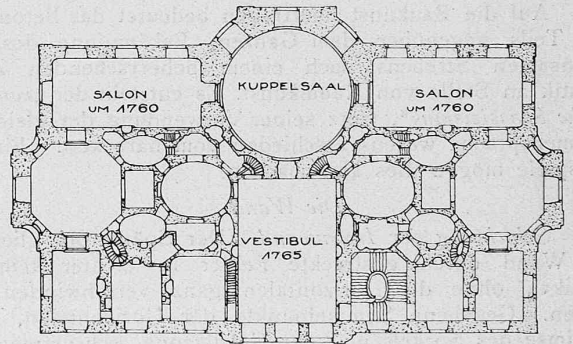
Nic. de Pigage, Grundriss vom Schlosse Benrath, 1756 bis 1769.
